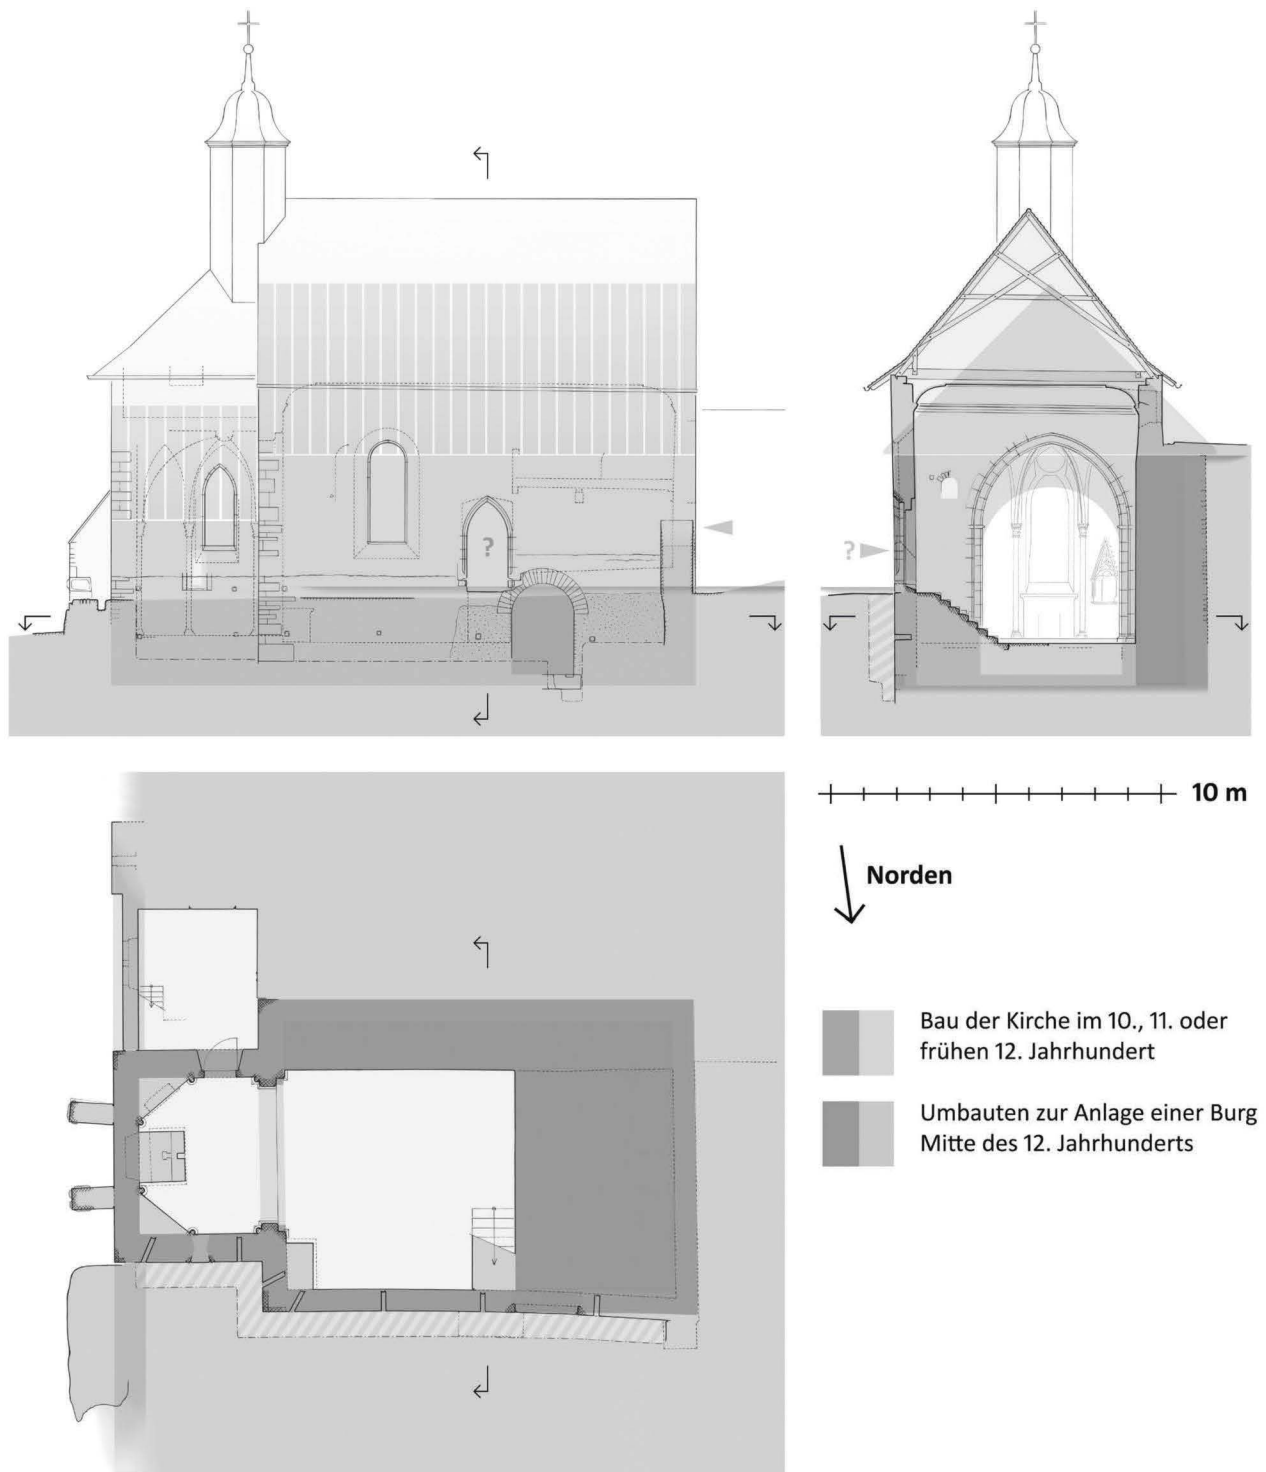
Riegel, Michaelskapelle. Umbauten zur Anlage einer Burg im 12. Jahrhundert im Aufmaß markiert. Nordansicht, Querschnitt und Grundriss auf Langhausebene (Zeichnung: King).
